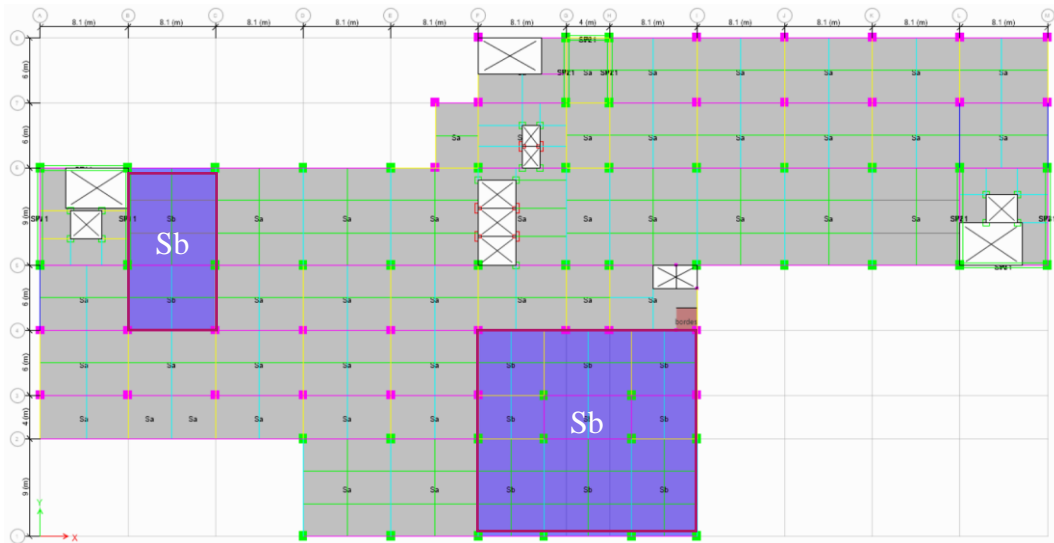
Pemodelan Denah Balok Lantai 1
